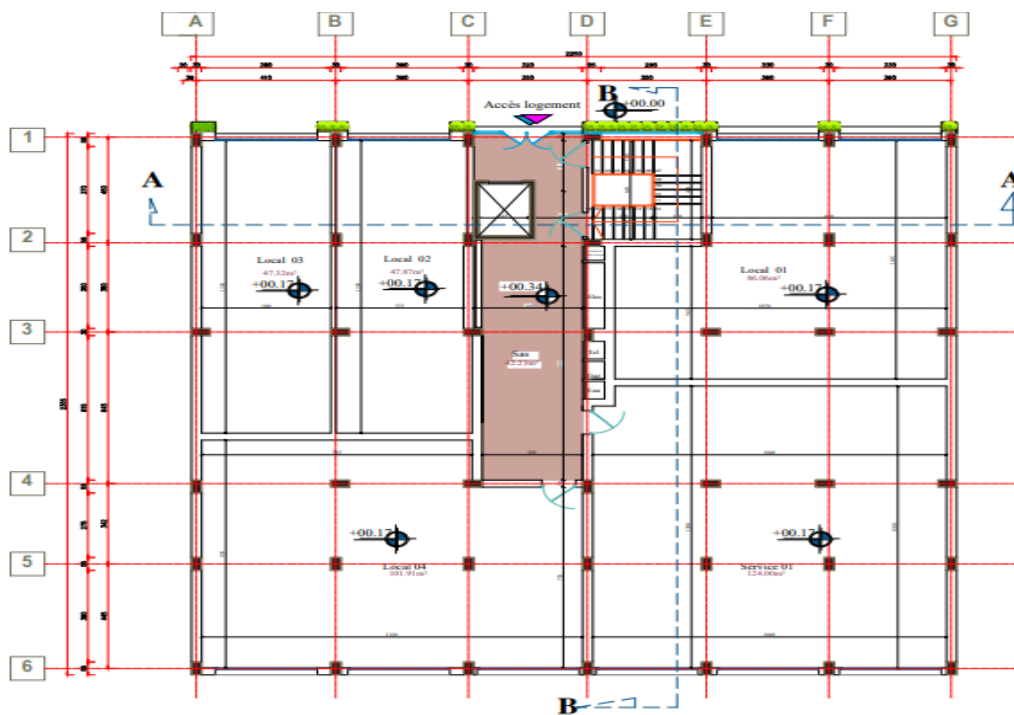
Plan du rez-de-chaussée (locaux commerciaux)
